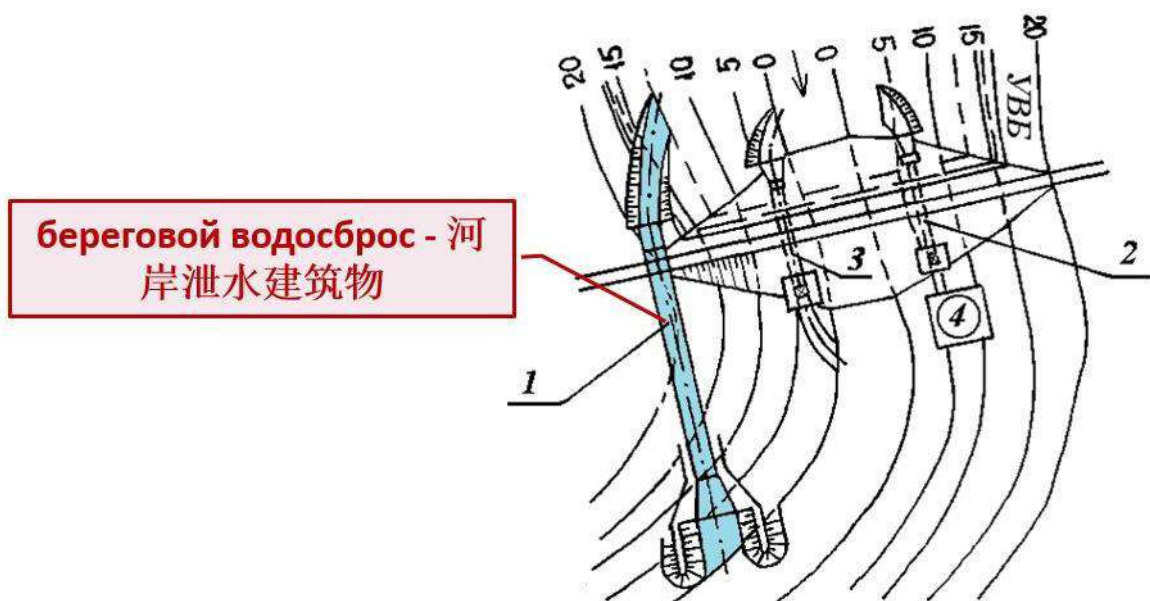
Генплан гидроузла с грунтовой плотиной и береговым водосбросом: 1— водосброс (береговой); 2 — водозабор; 3 — совмещенный водоспуск-водоотпуск в нижний бьеф, по которому можно пропускать и строительные расходы; 4 — насосная станция
